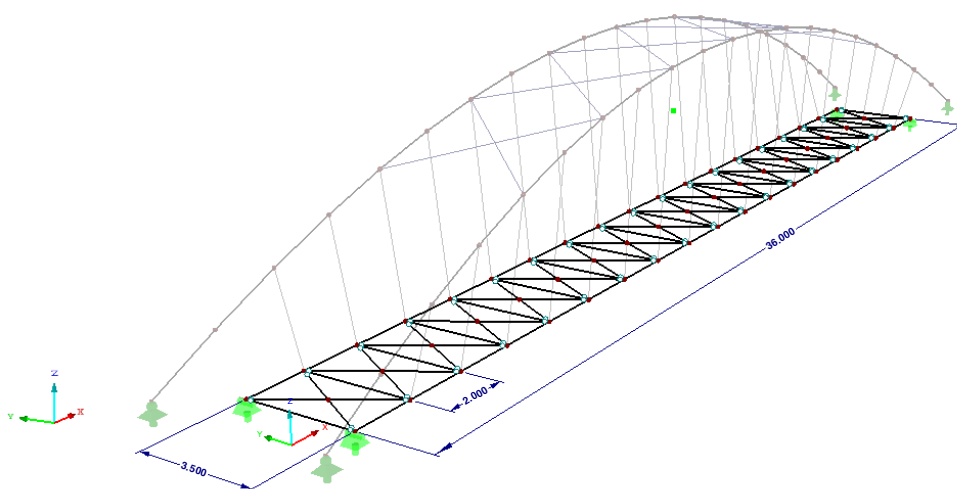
Tabuleiro (vigas principais, vigas transversais e contraventamentos) (Dlubal)
